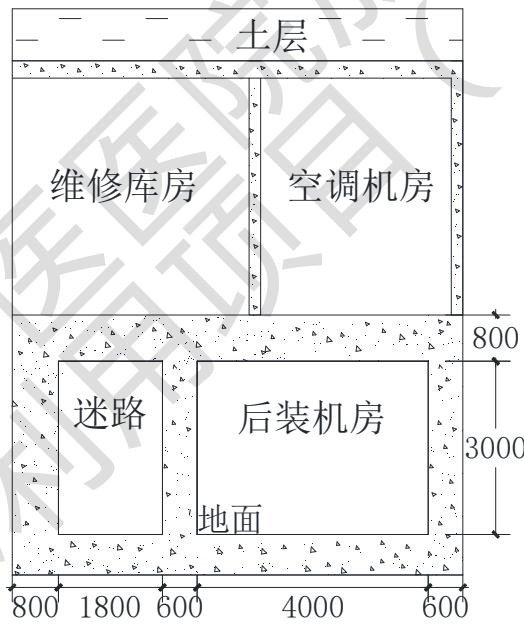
后装机房屏蔽示意剖面图（剖面 3-3）（单位：mm）
